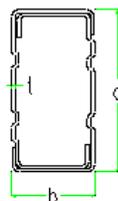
Geometría de Viga "O" 2"x4"x2.0mm
